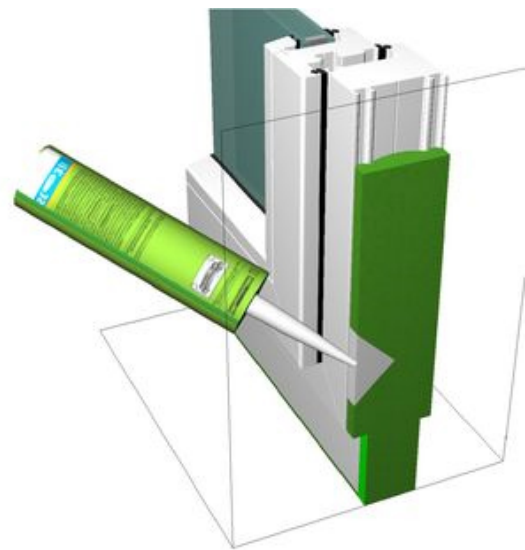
Instrukcja montażu do elementów utrudniających włamanie na przykładzie okna jednoskrzydłowego obrotowo-uchylnego
